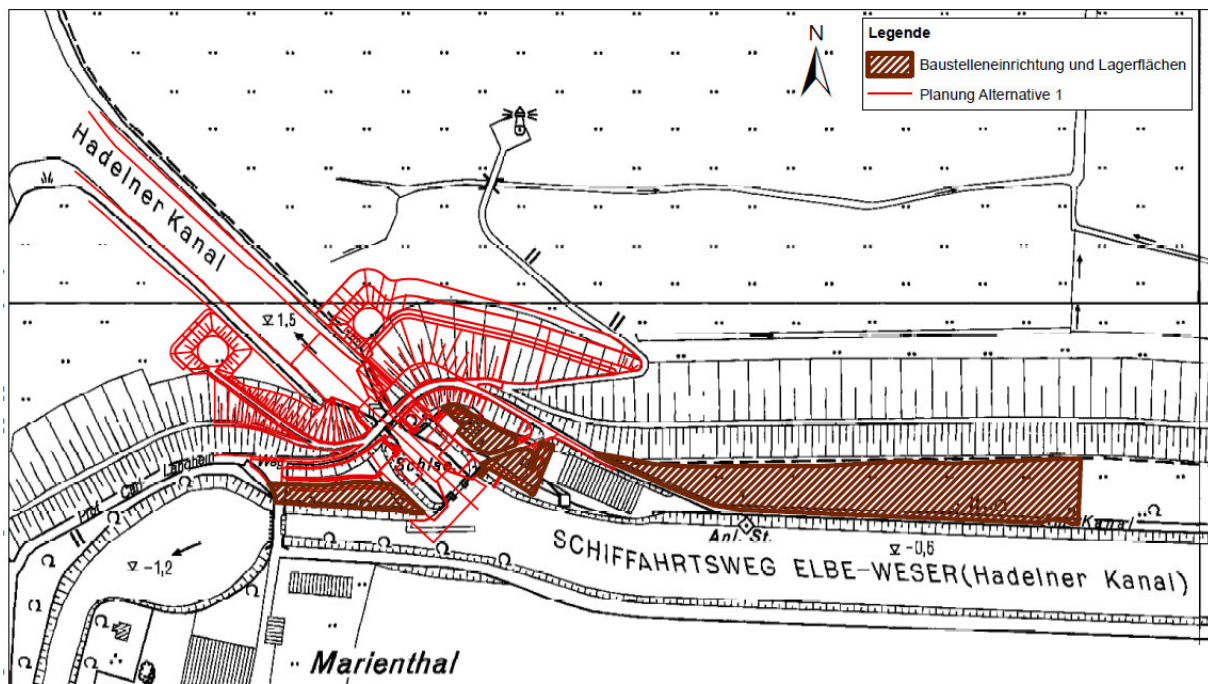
Lage Baubüro und Lagerfläche (unmaßstäblich)
